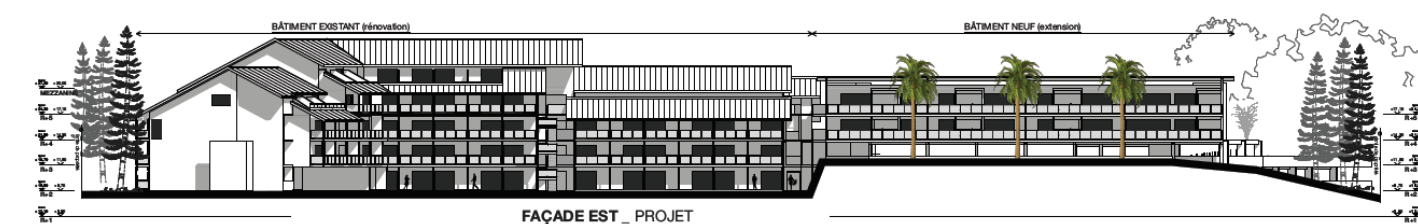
Façades Est (Source : PC février 2020 – ARCHI 13)
